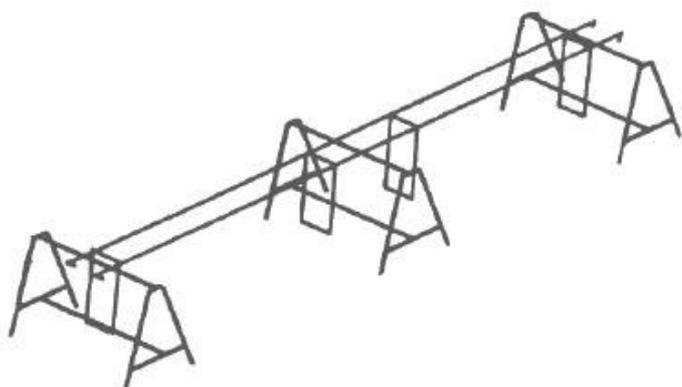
Montagem de armaduras sobre cavaletes – fase 1.
